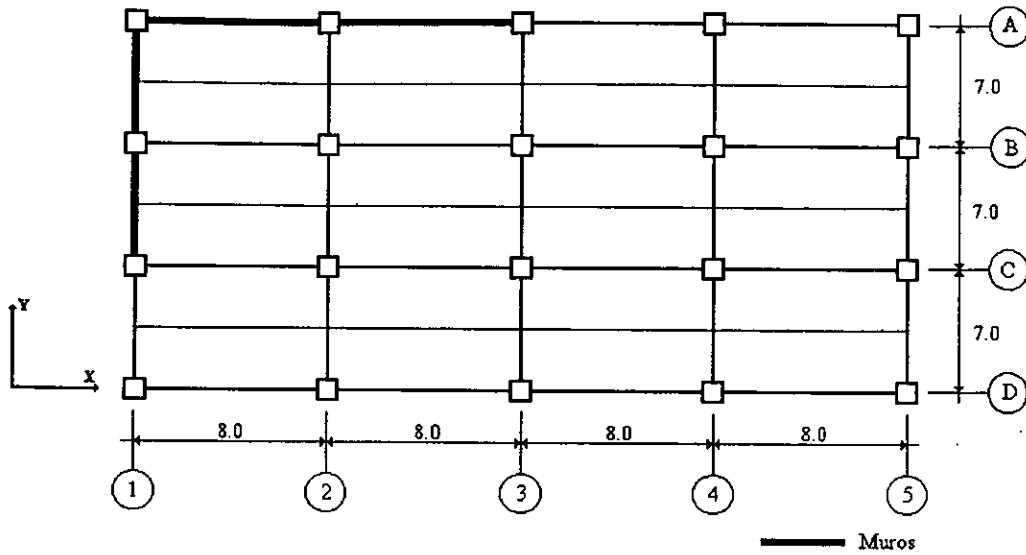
Planta de modelos excéntricos en rigideces, 2 muros en cada dirección.
